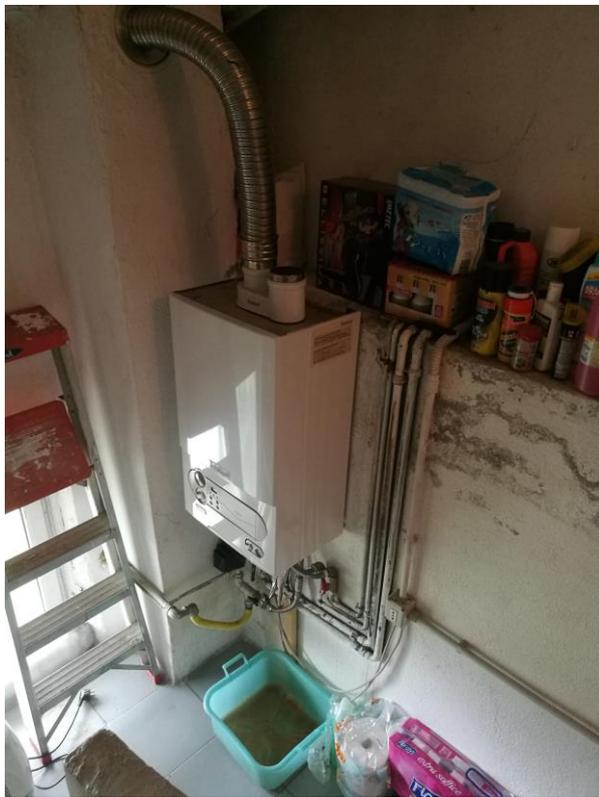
PIANO PRIMO/SECONDO – particolare caldaia posta su scala interna fra appartamento e solaio.
